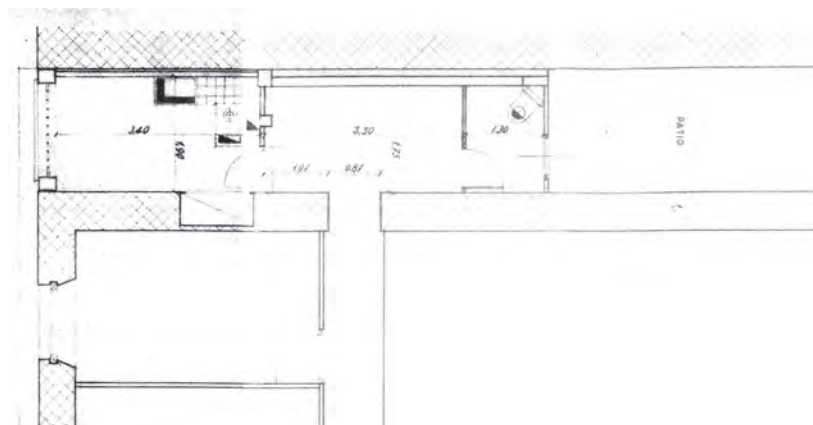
34. PLANTA DEL PRIMER PISO
